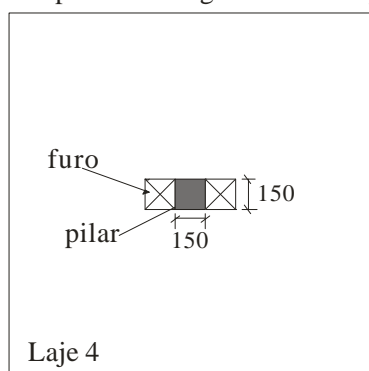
Armadura das lajes do Grupo 4 - (SILVA, 2003)
